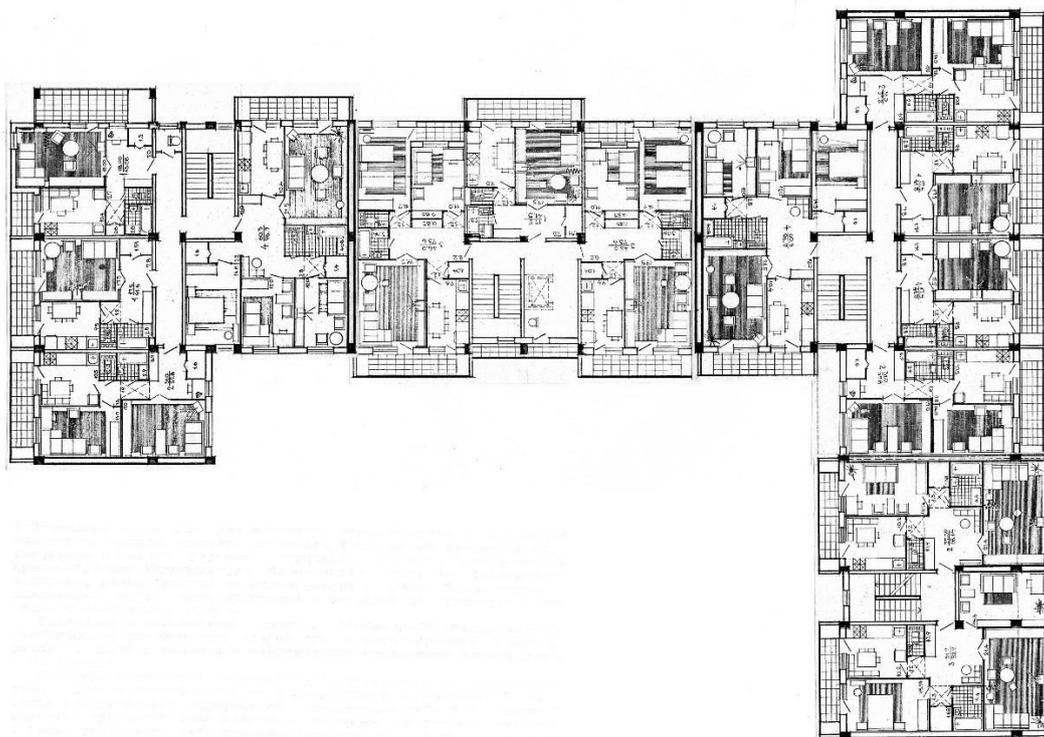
Житловий будинок на основі безригельного каркасу із сіткою колон 7.2x7.2.
